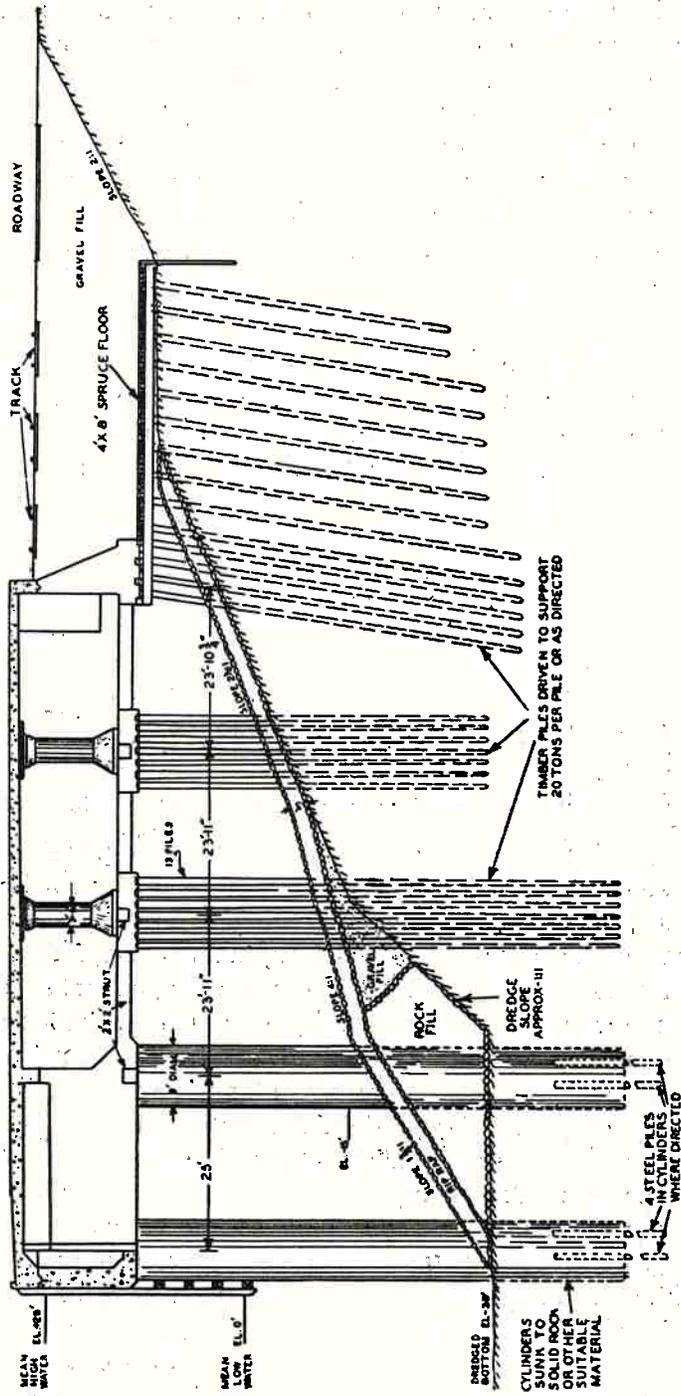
Estrutura de tubulões no porto St. John-Canada
